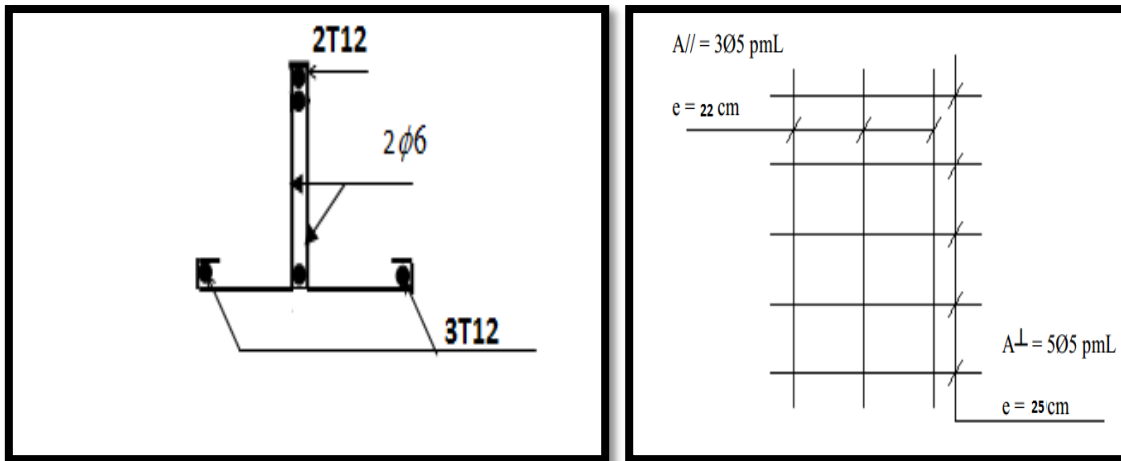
Ferrailage de la Poutrelle Fig. III.13. Ferrailage de la dalle de compression.
